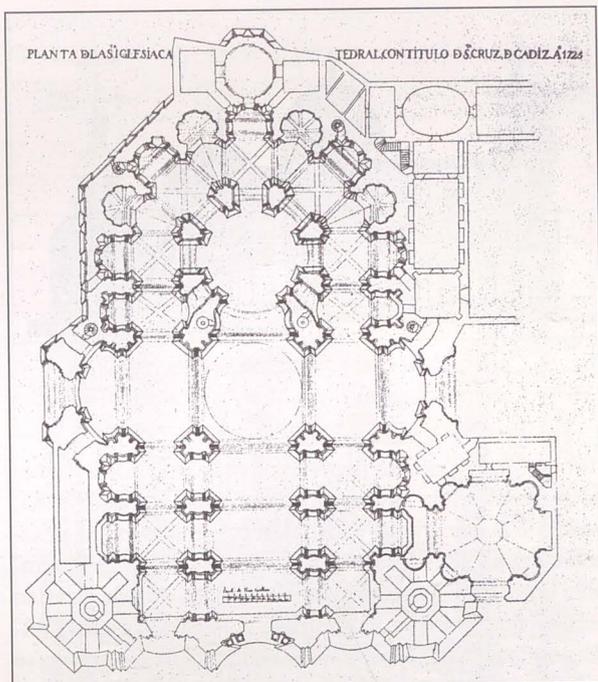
Catedral de Cádiz. Planta de 1725 sobre el calco de Pablo Gutiérrez Moreno (1928).
